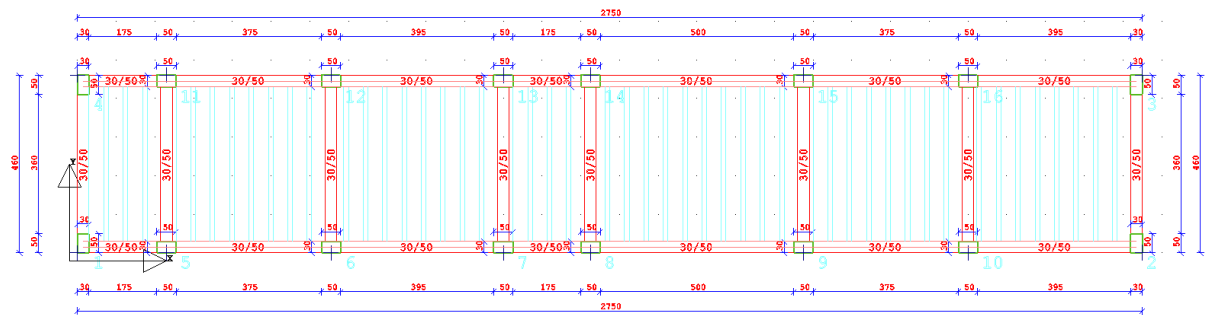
Pianta strutturale impalcato a quota 0,00 dell'edificio di consegna
